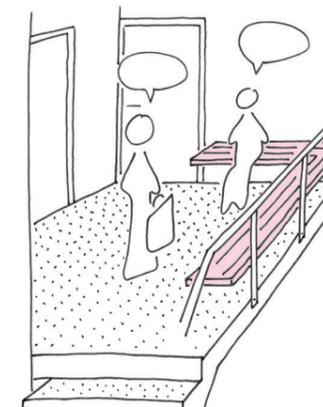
Gelegenheitsstrukturen in baulichen Details, z. B. auf Treppenpodesten
